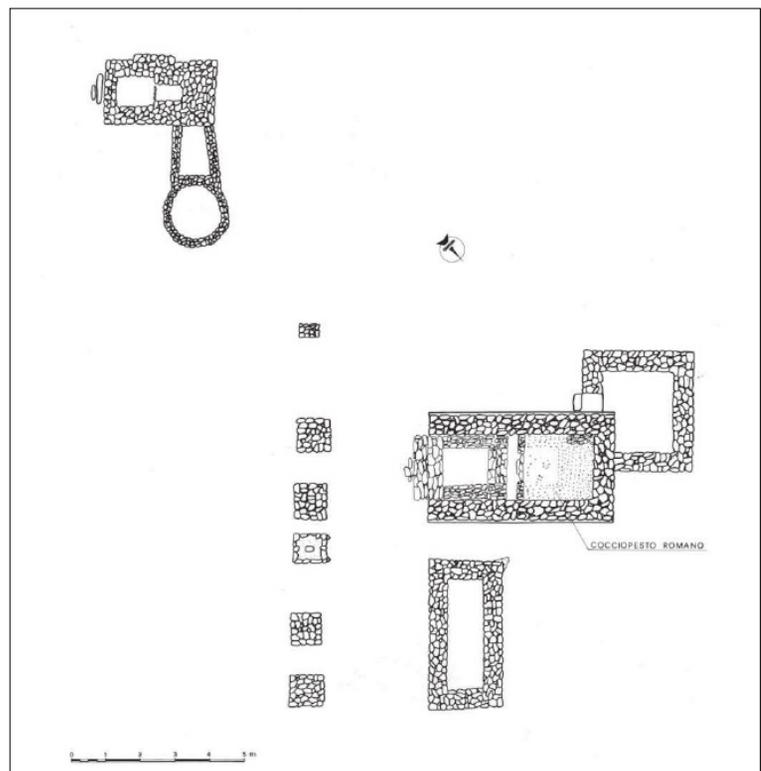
Planimetria dell'area sacra presso Strumpu Bagoi (Barreca 1986: fig. 85).
